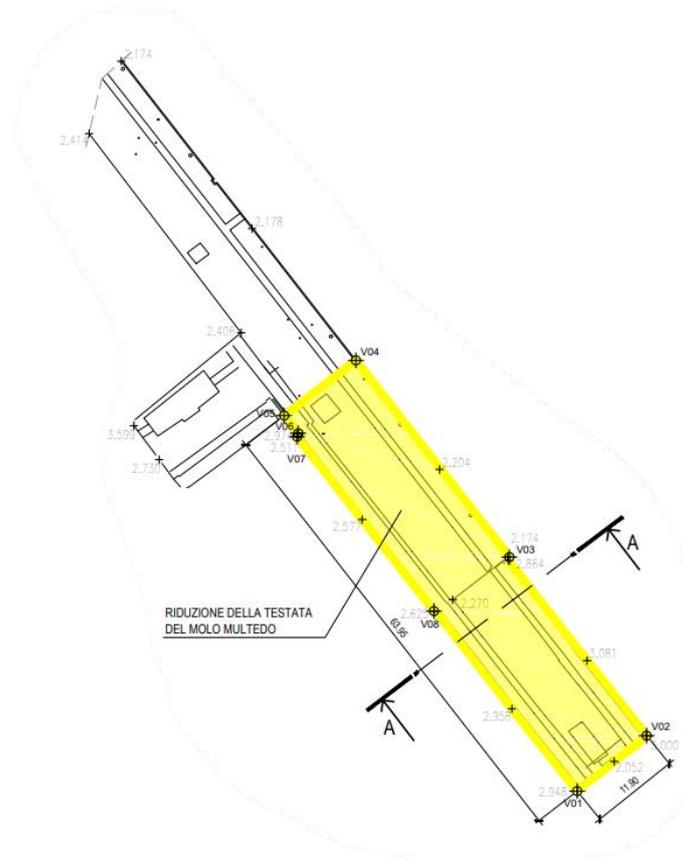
Planimetria del molo Multedo con evidenza del tratto da demolire
